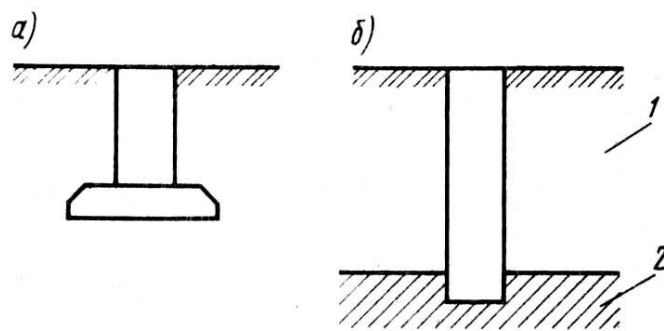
Устройство фундаментов в надёжных грунтах (тип 1):
